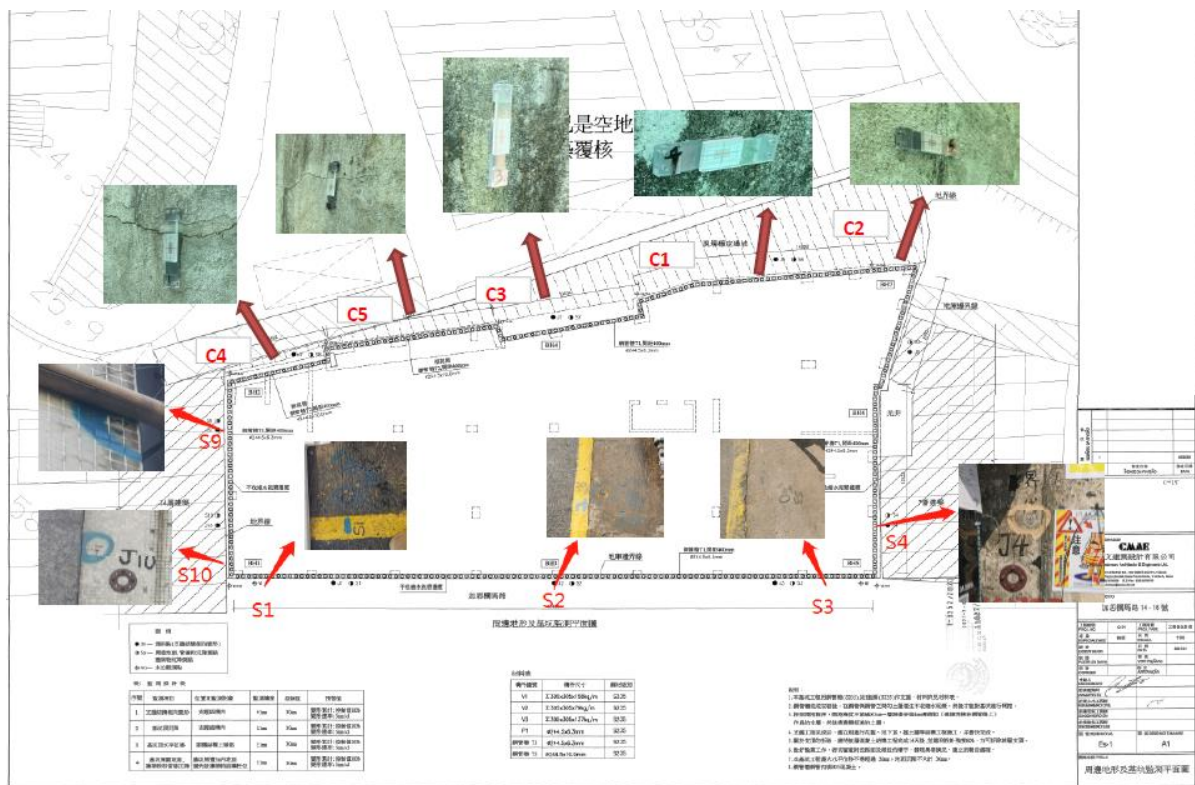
Planta de localização do ponto de amostragem do estaleiro privado (2)
